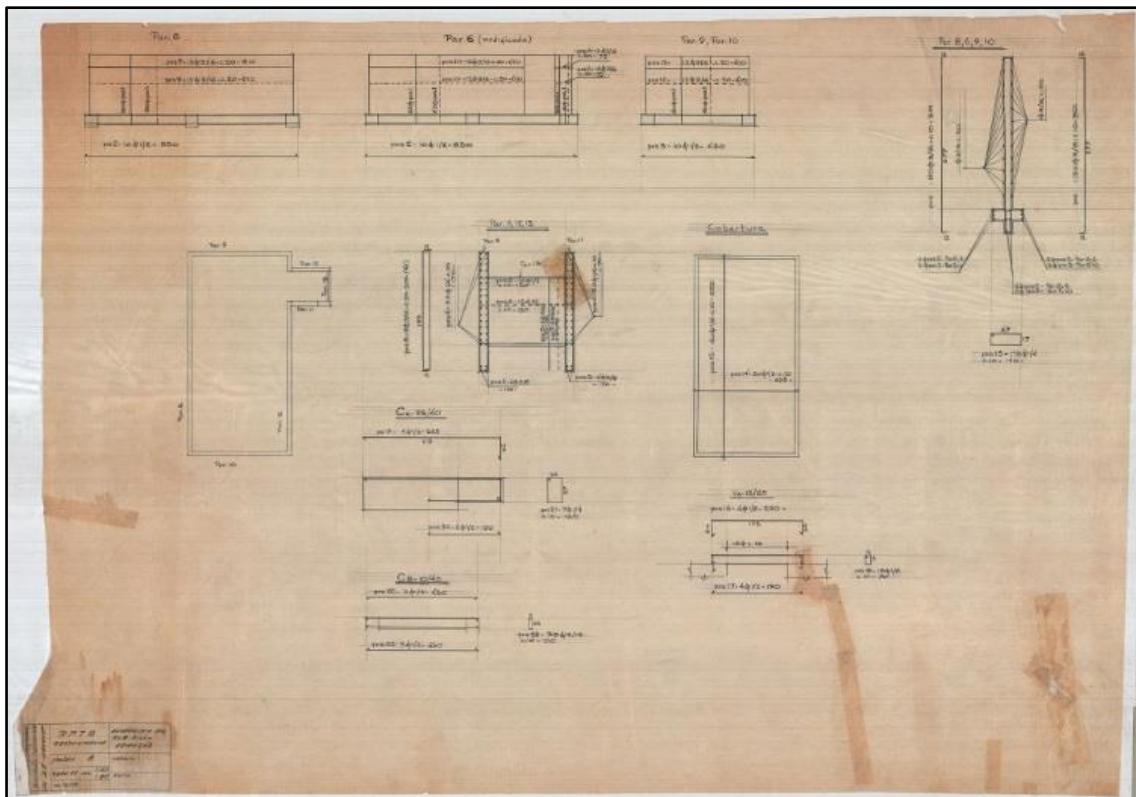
Jun. 1966 – RPTP-Restaurante. Folha 5. Escalas 1:50 e 1:20. Acréscimo do Subsolo – Armação – DE NOVACAP. Arquivo: e129-m5 (9) Fonte: ArPDF
